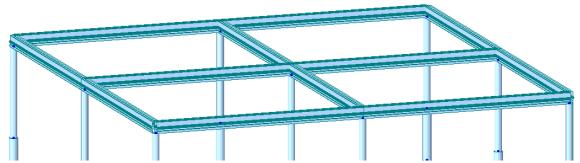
Vista assonometrica parte sommitale struttura di sostegno
